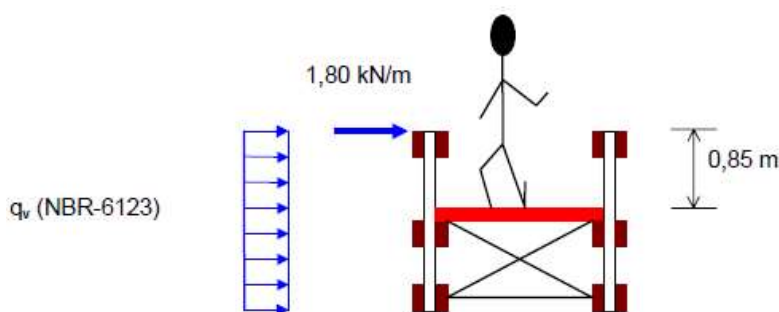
Vento sobre passarela (Fonte: Manual de projeto e construção de pontes de madeira – LaMEM)
